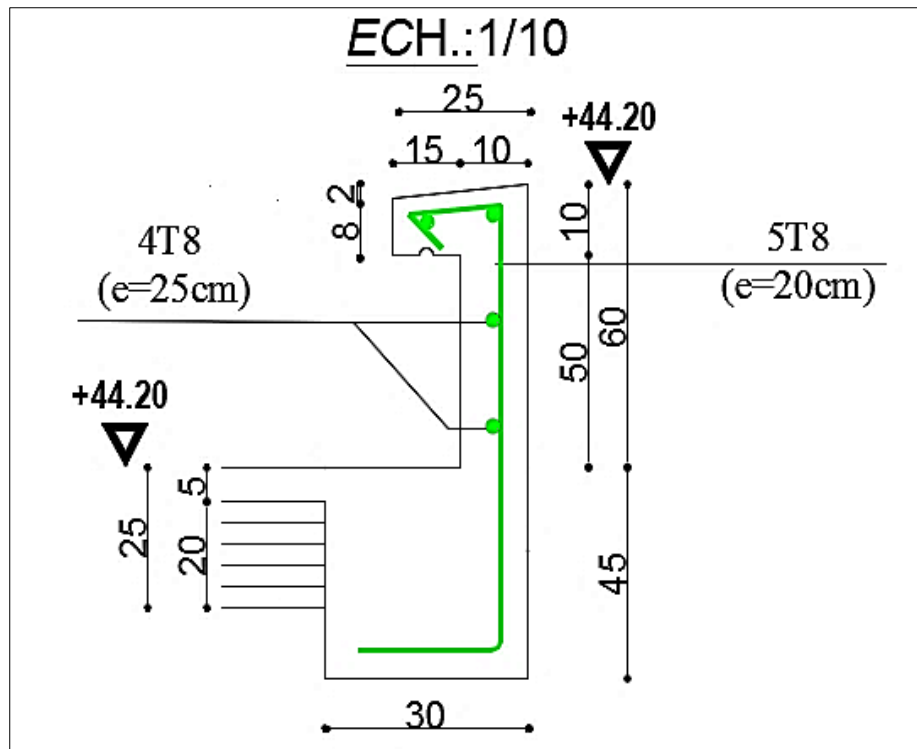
Dessin de ferrailage de l'acrotère.
